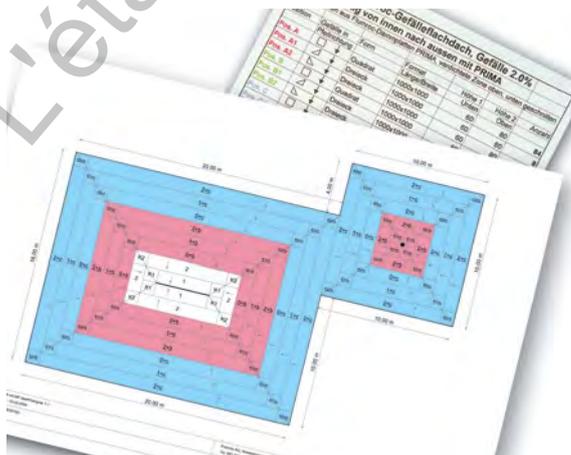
/402: Panneaux isolants en pente; croquis du système (en haut), plan de pose (à droite)
